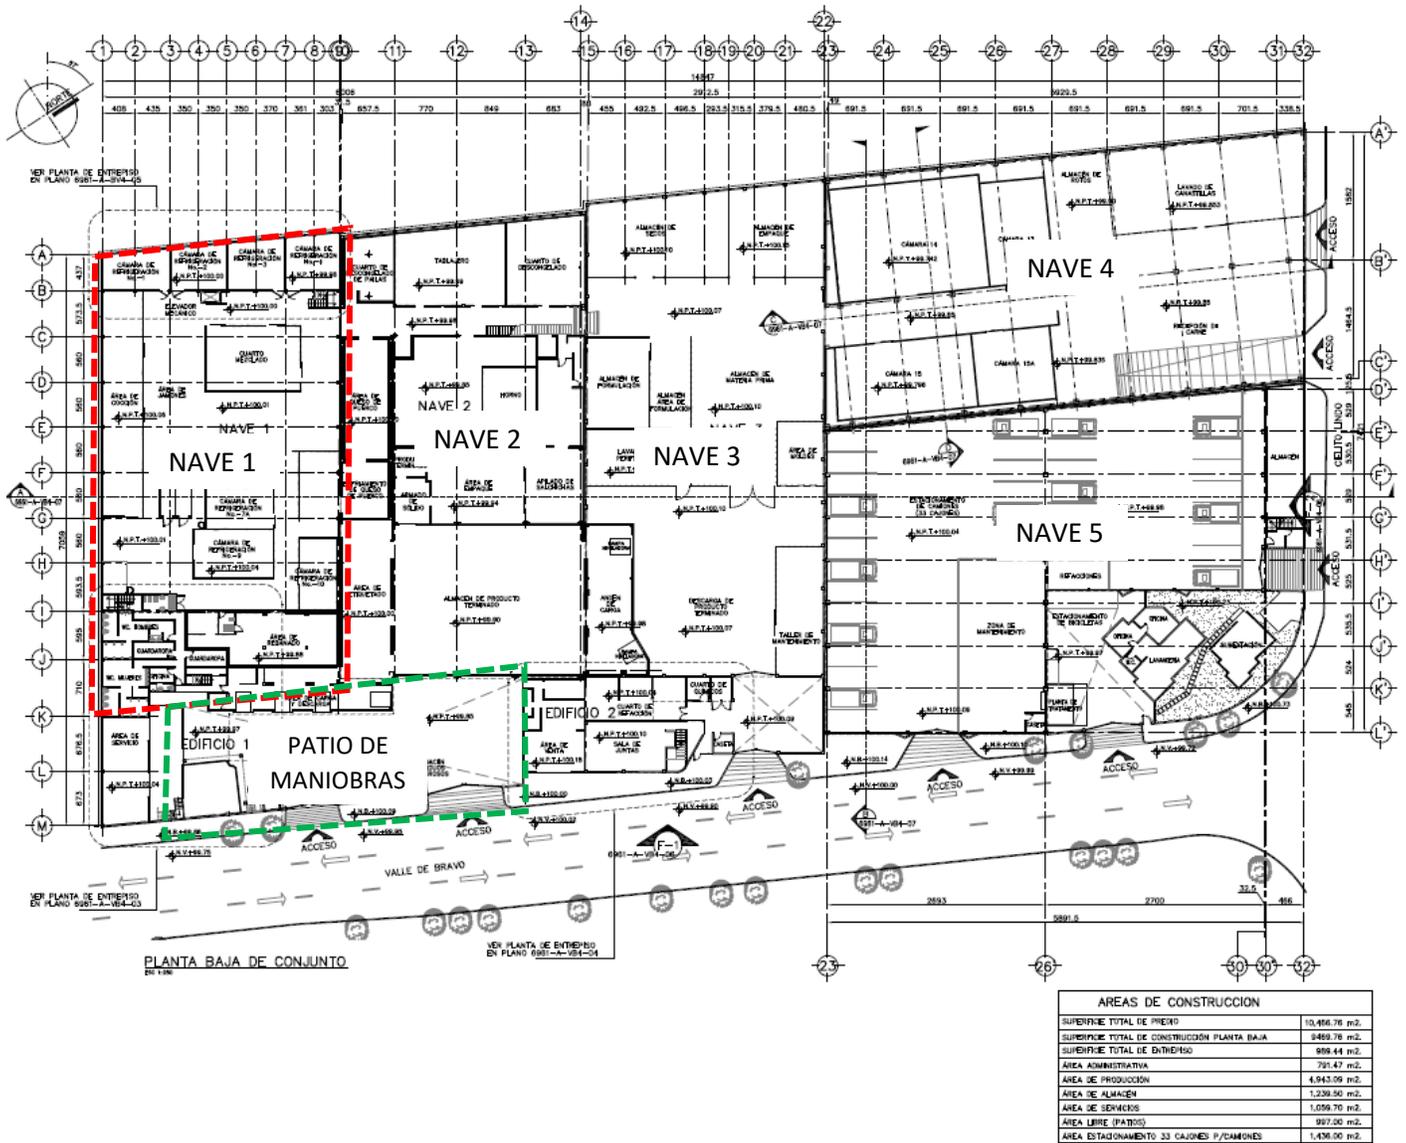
Plano de estado actual del sitio, con ubicación de la nave y el patio de maniobras
